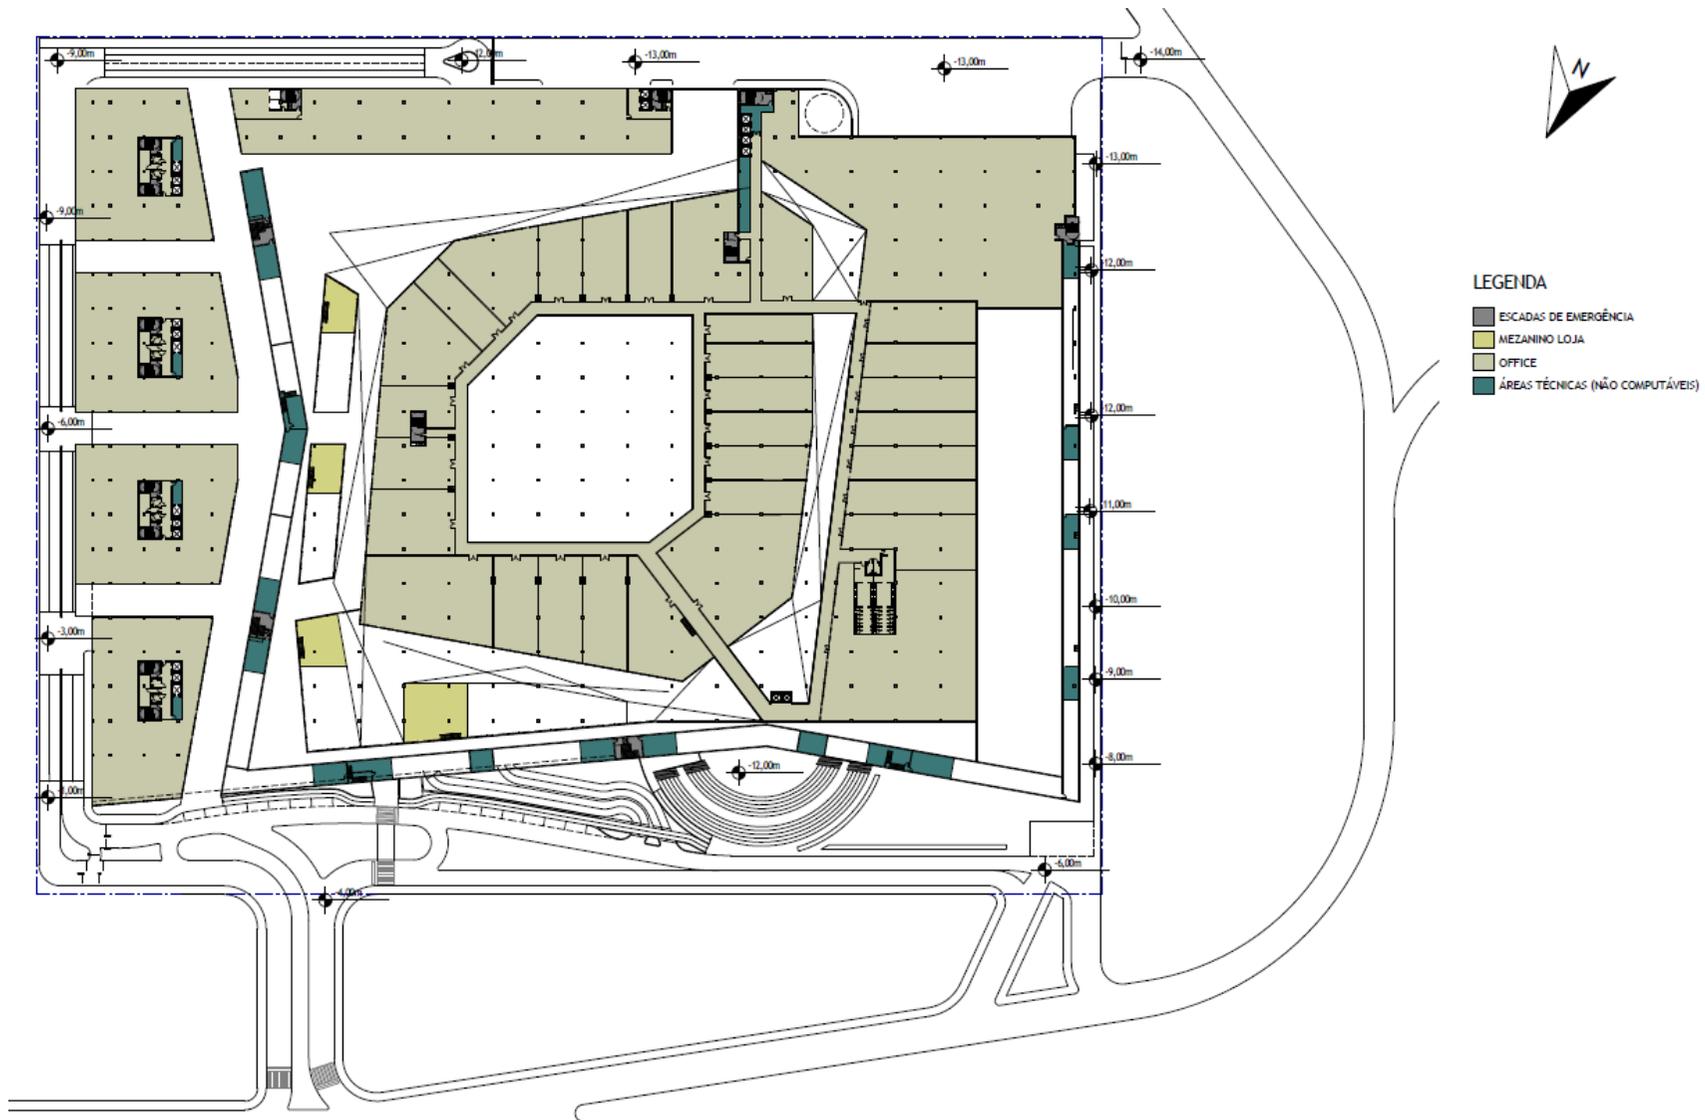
Planta baixa 3Pavimento (L4), Nível 9,00m
